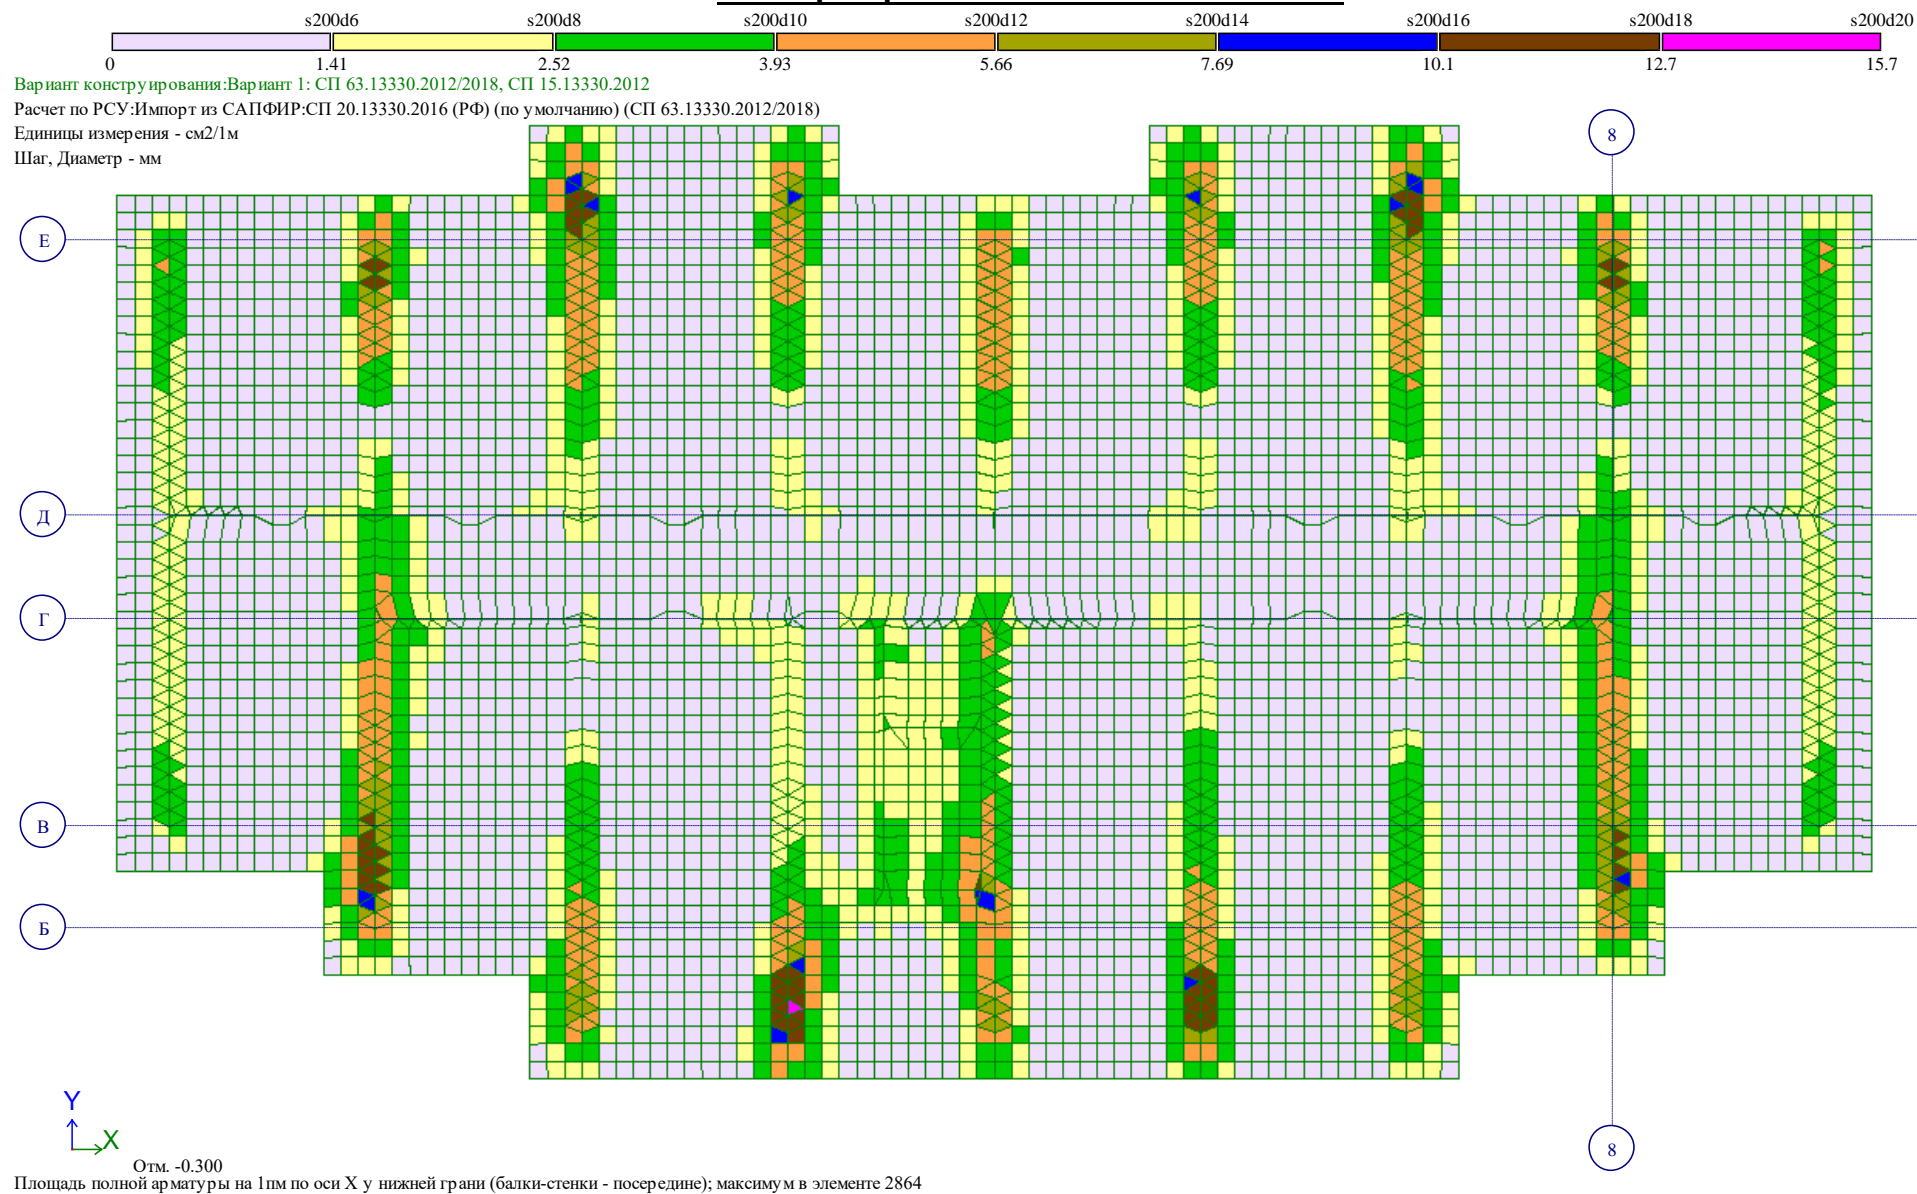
Площадь полной арматуры на 1пм по оси X у нижней грани
